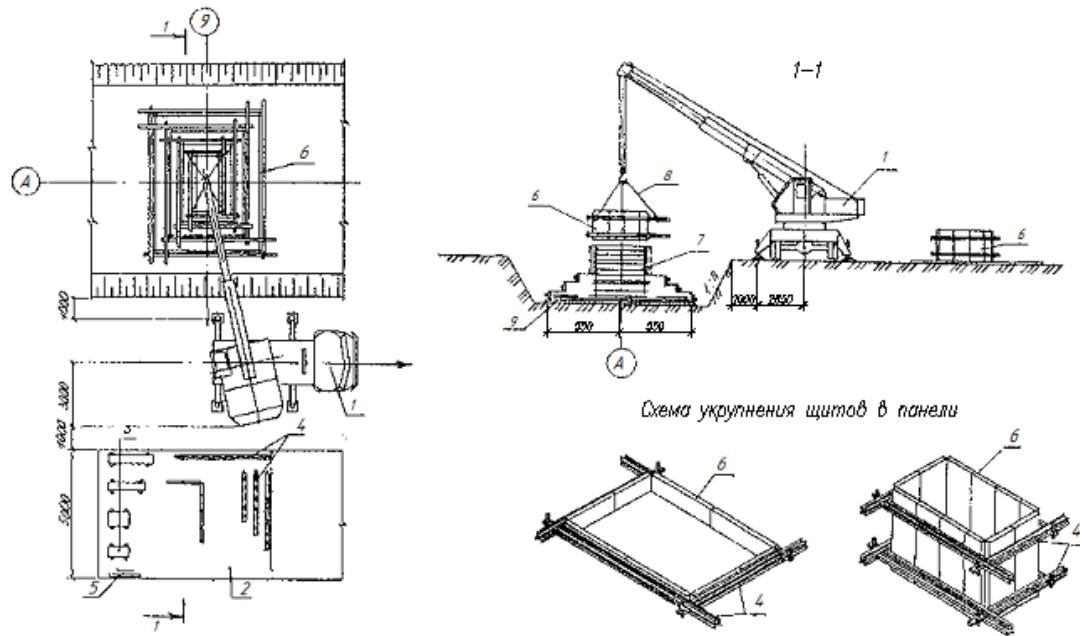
Раскладка щитов опалубки фундамента ФМ-1.
